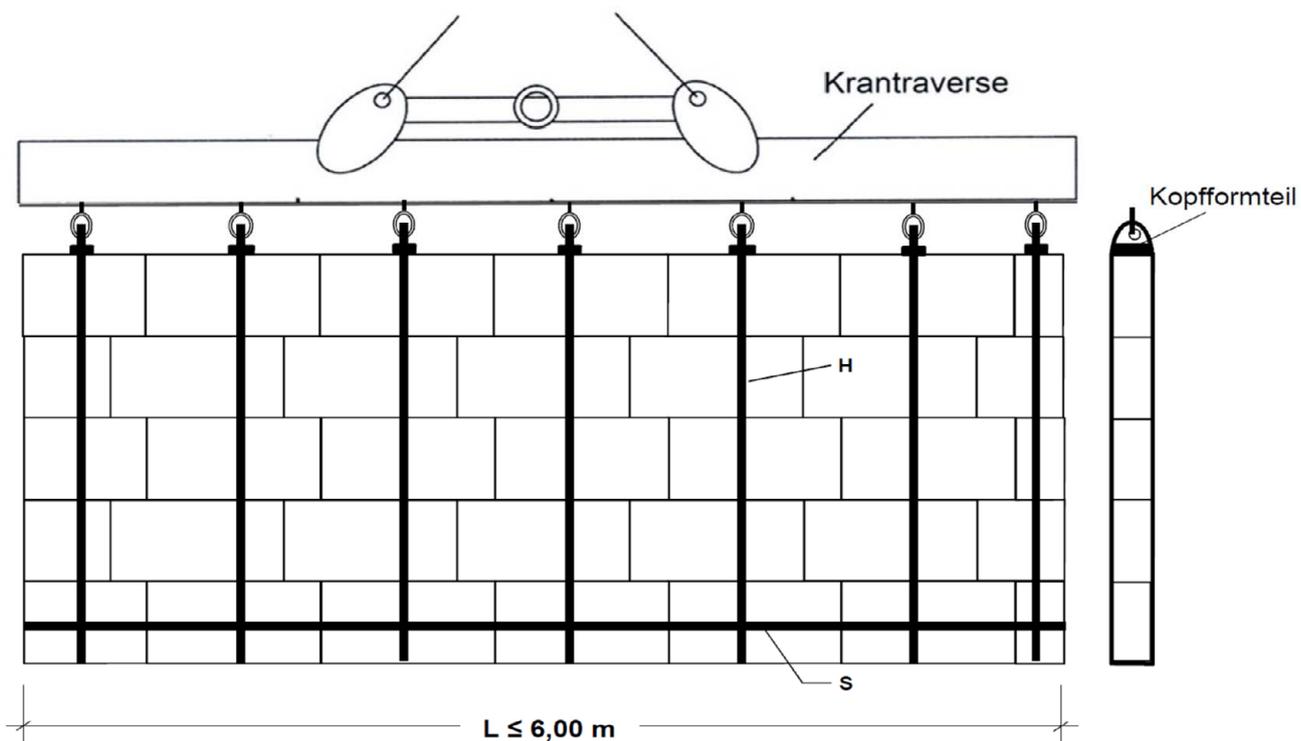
Mauertafel mit KS-Planelementen, Steinlängen ≥ 898 mm
